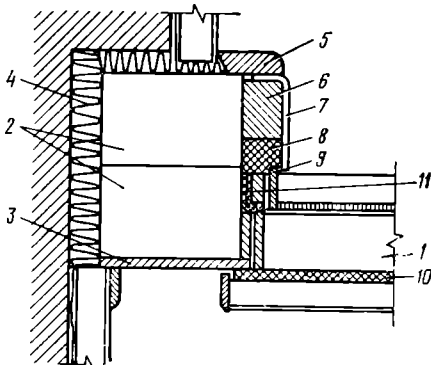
Конструкция студийных дверей: 1 — дверное полотно; 2 — бруски коробки; 3 — дубовая облицовка; 4 — минеральный войлок; 5 — наличник; 6 — наклад; 7 — скоба; 8 — наклад; 9, 10 — губчатая резина; 11 — прорезиненная ткань
